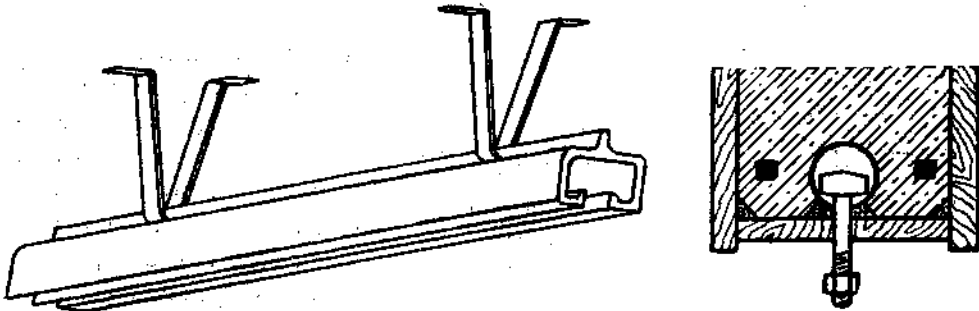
и 224. Подвешивание трансмиссий к железобетонному перекрытию.
